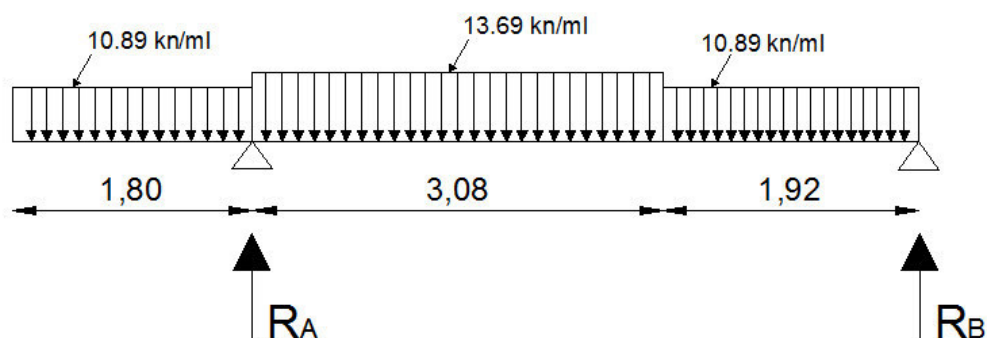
Schéma statique des escaliers à l'ELU.
